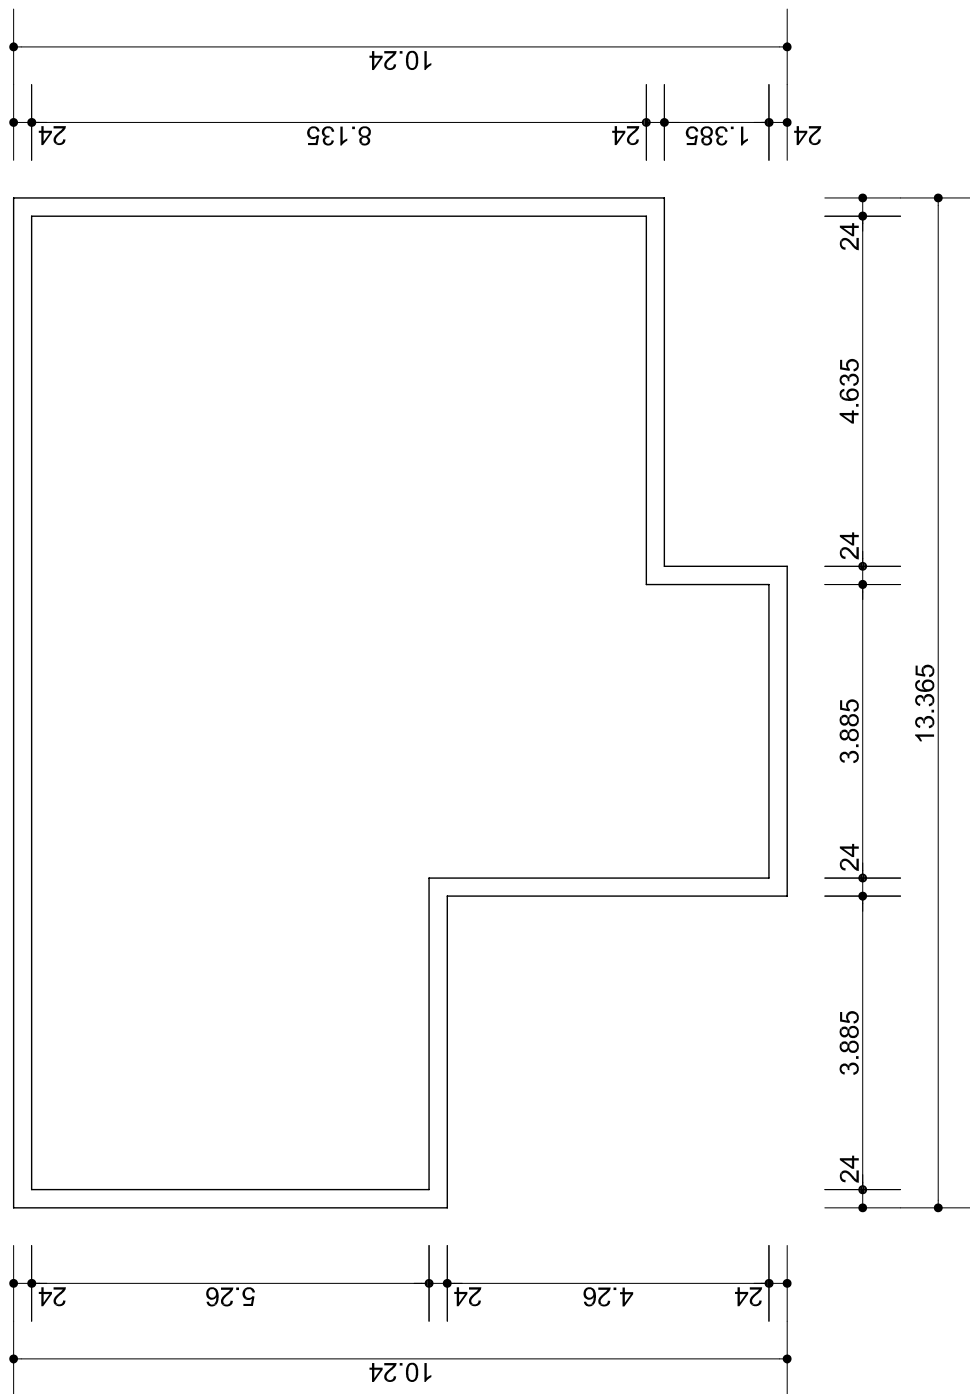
Übung 3 Grundriß 1 mit Bemaßung
